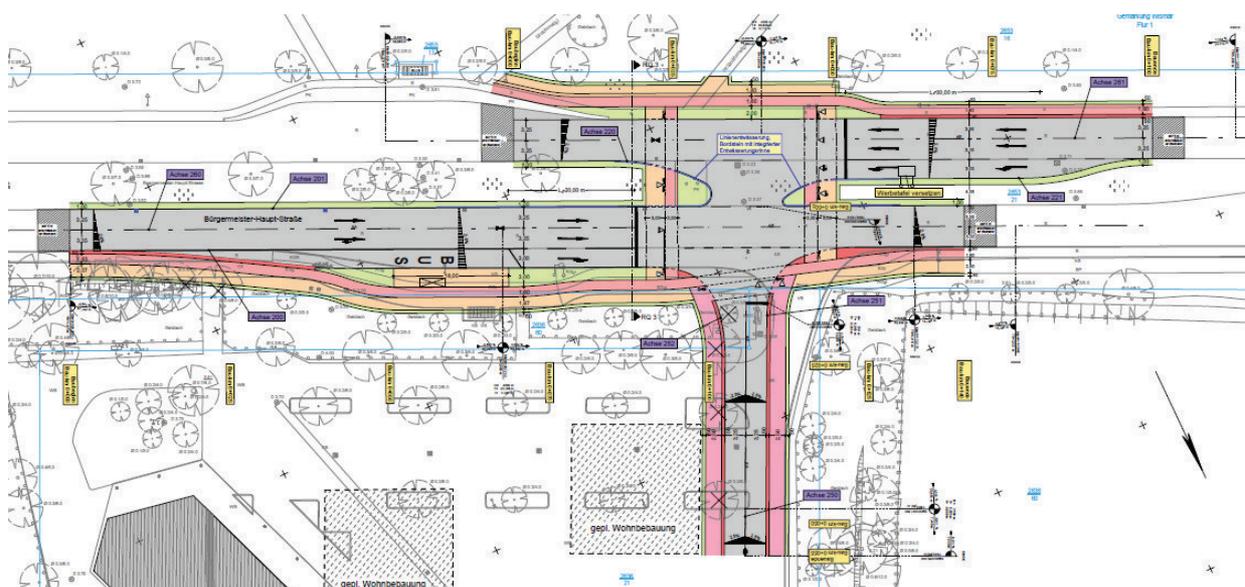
Erschließungsplanung Bürgermeister-Haupt-Straße mit Anbindung an Plangebiet. Quelle: Ingenieurbüro Klaeser; Waren (Müritz); Stand: November 2019
